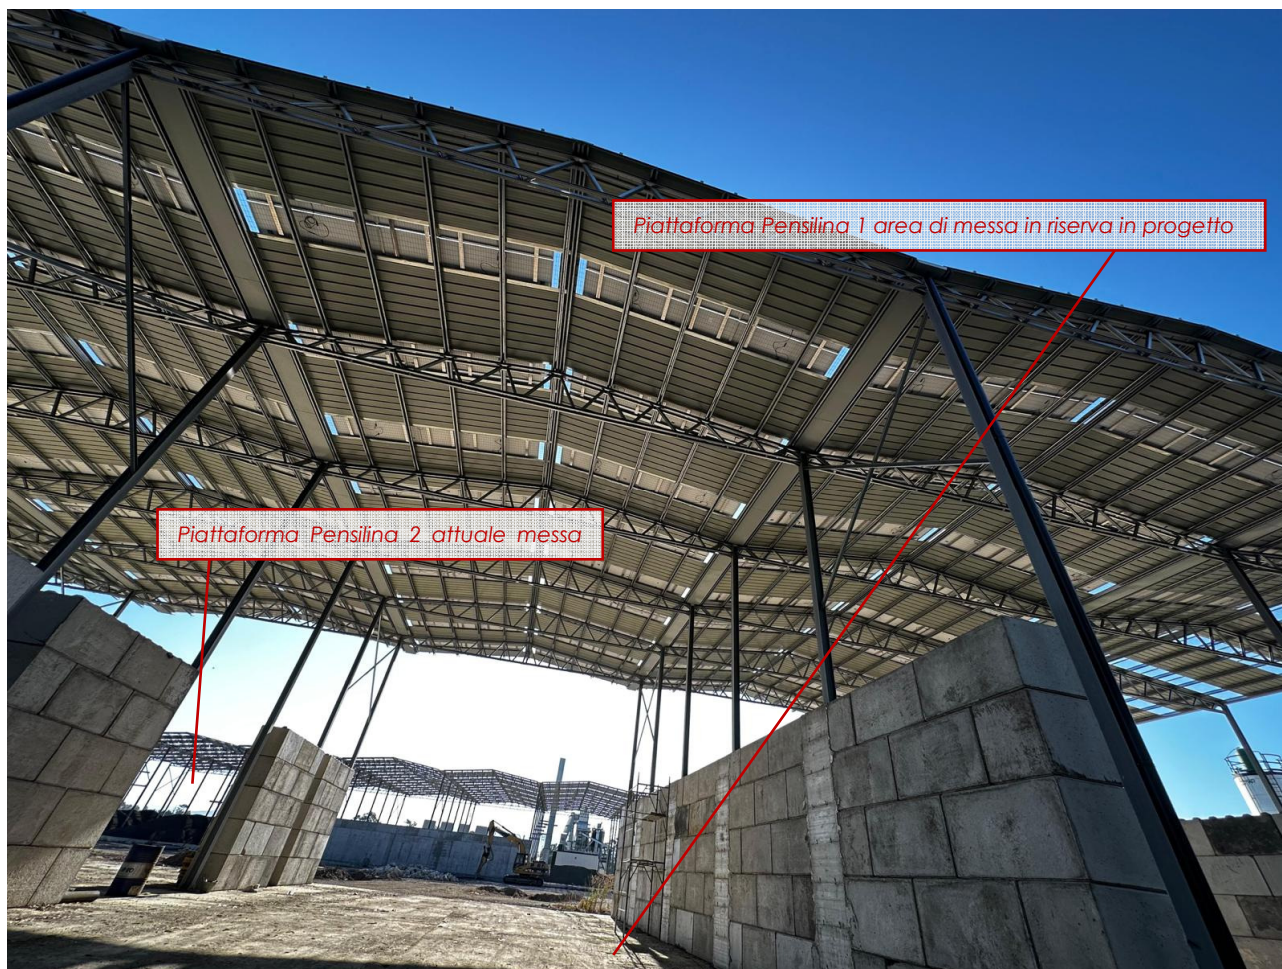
Foto prospettica delle pensiline 1 e 2
